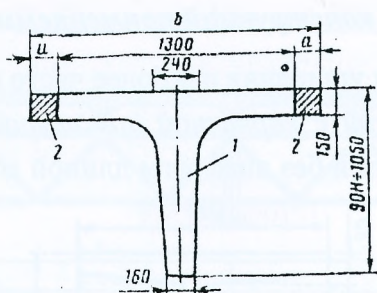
Поперечное сечение балки бездиафрагменных пролетных строений.
